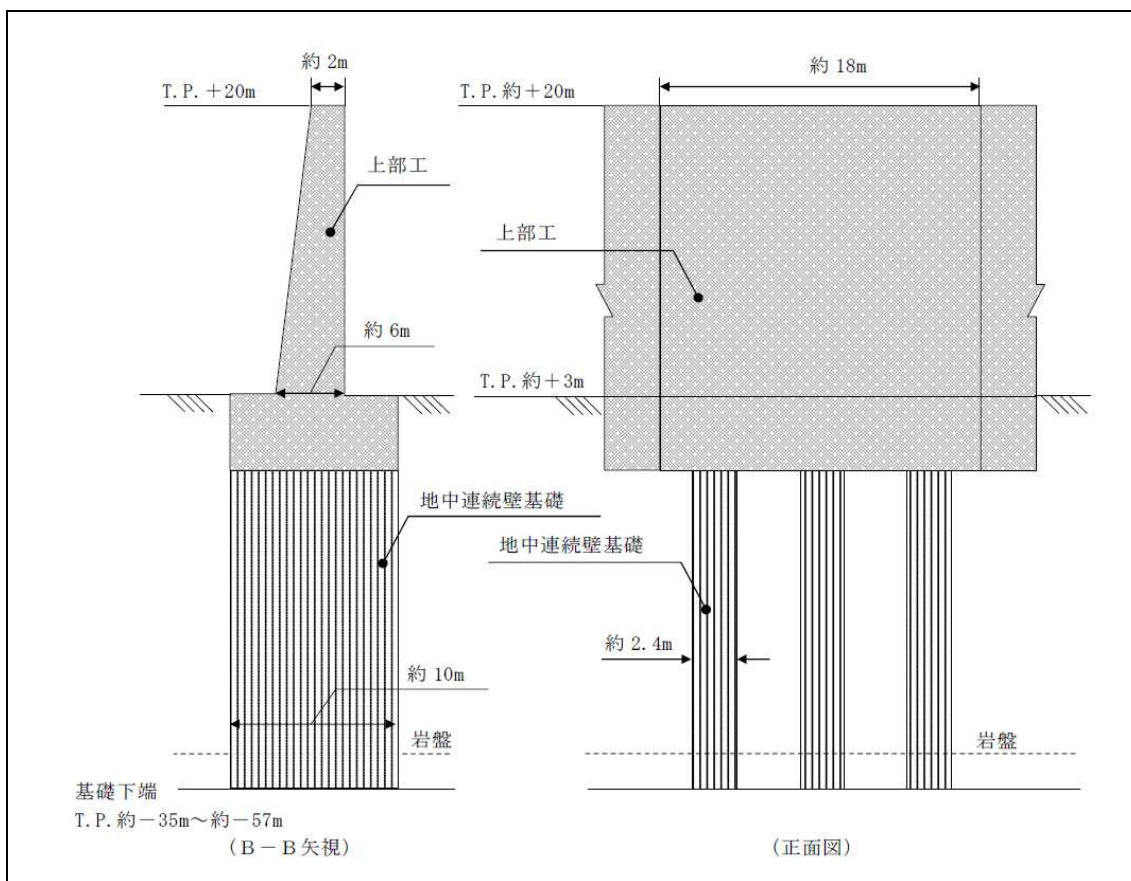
鉄筋コンクリート防潮堤の構造図（海水ポンプエリア）（原電 東海第二）
